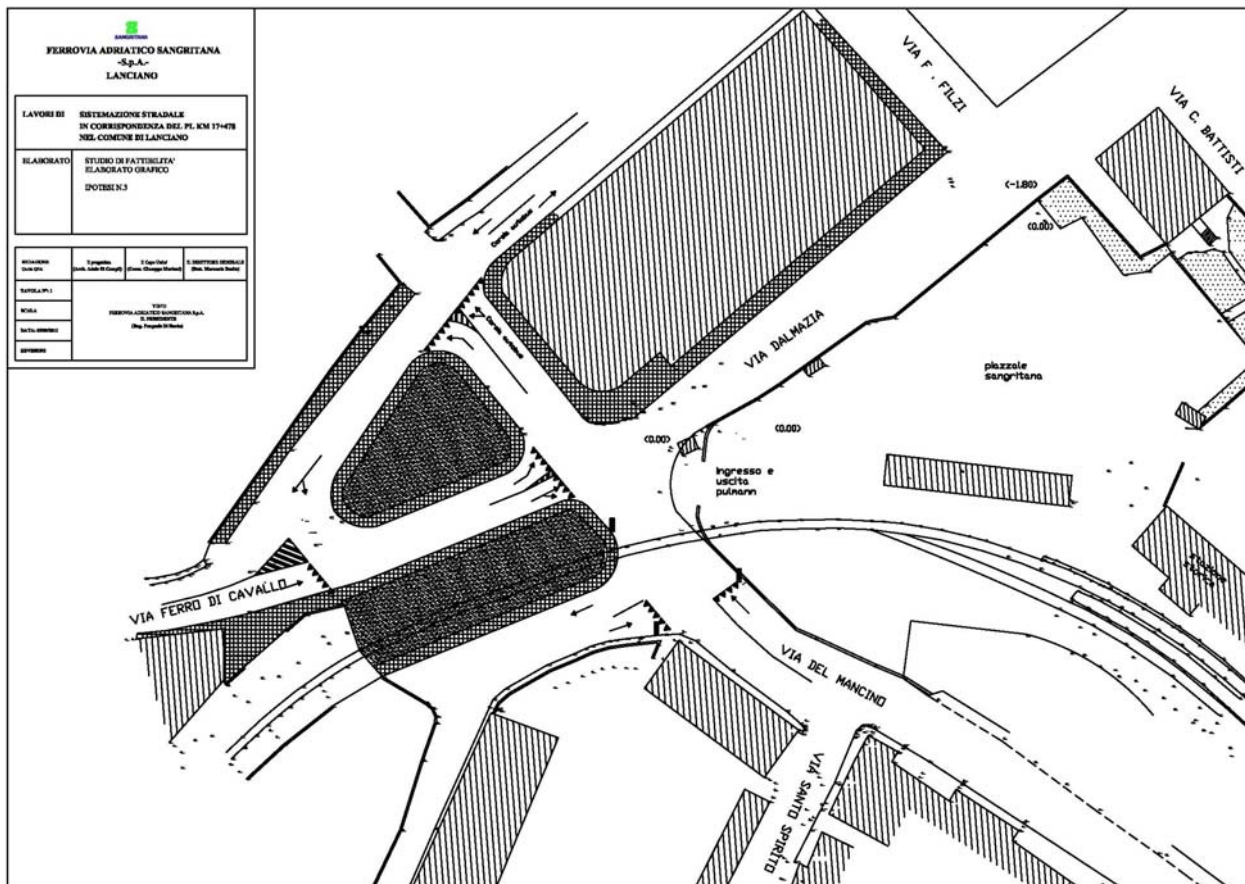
Layout della nuova sistemazione dell'intersezione proposta dalla Ferrovia Adriatico Sangritana Spa
